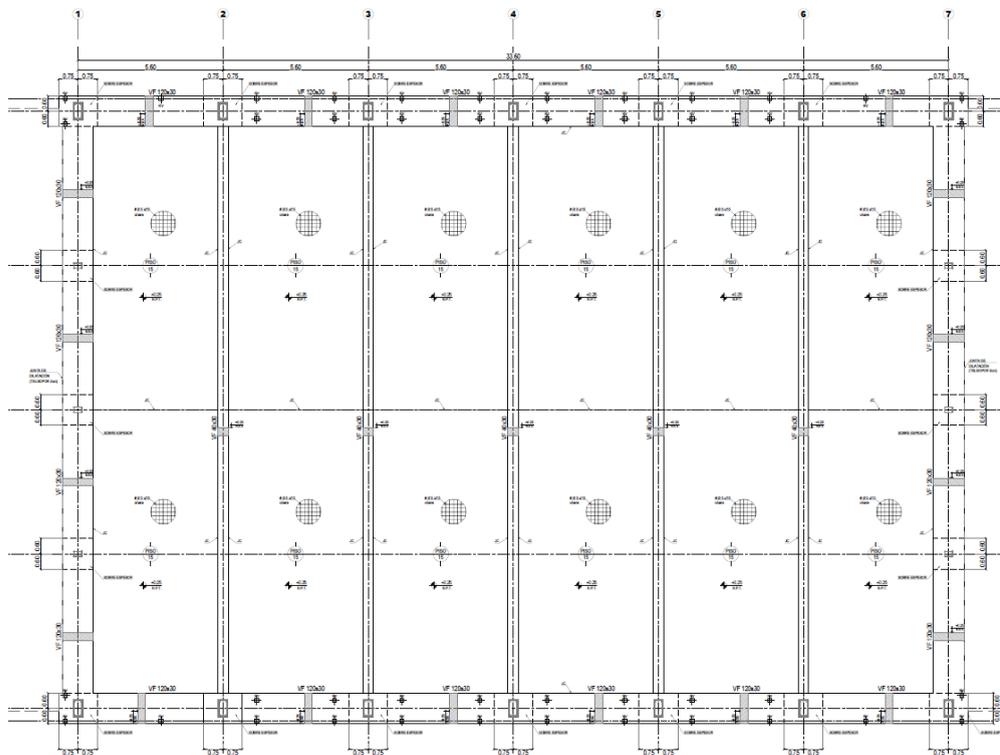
FUNDACIONES DE CUBIERTA | PLANTA
